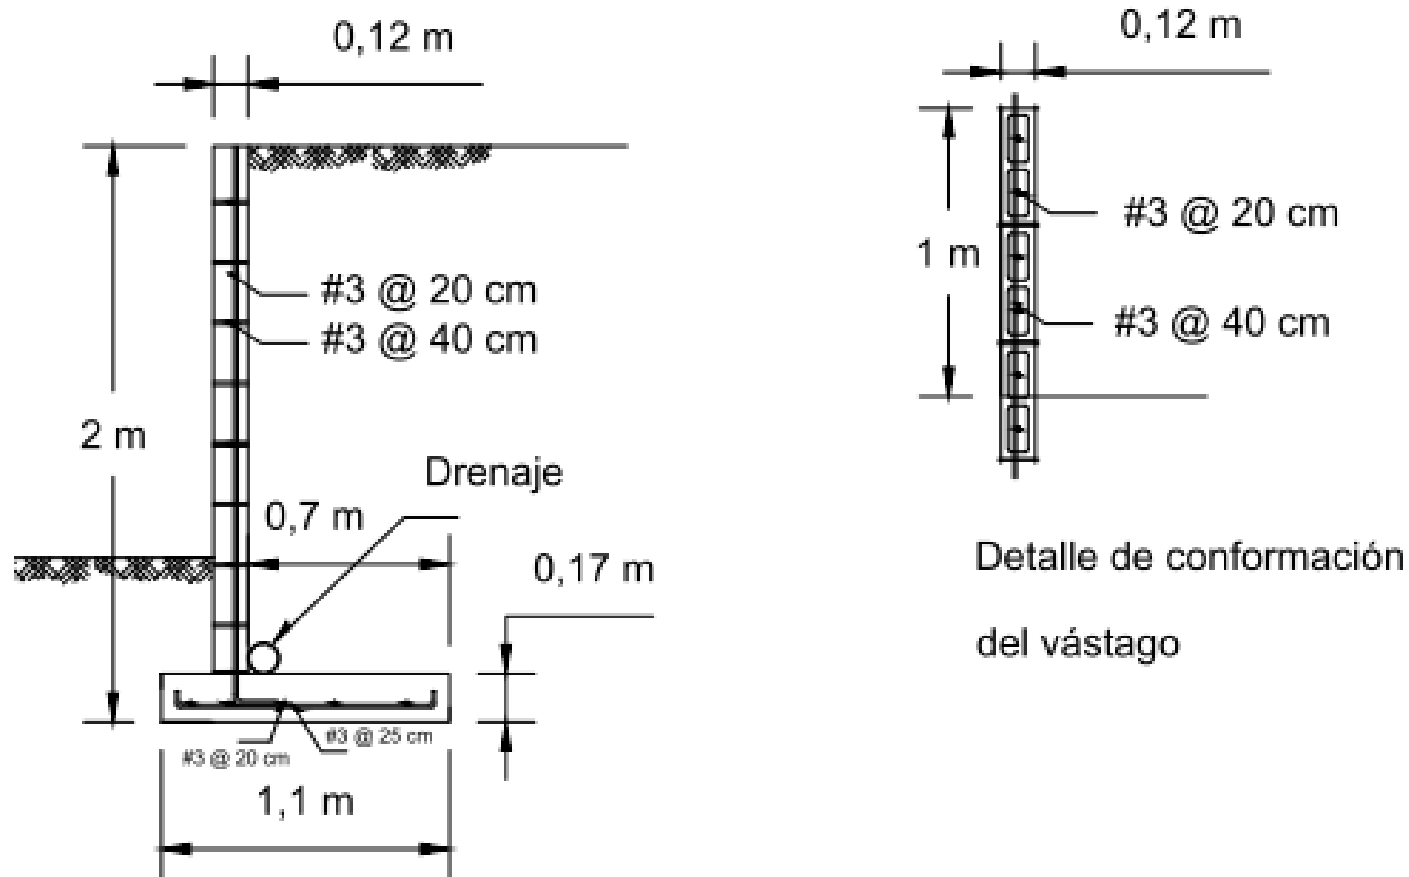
Muro de mampostería de 2m de altura con un suelo tipo S1
